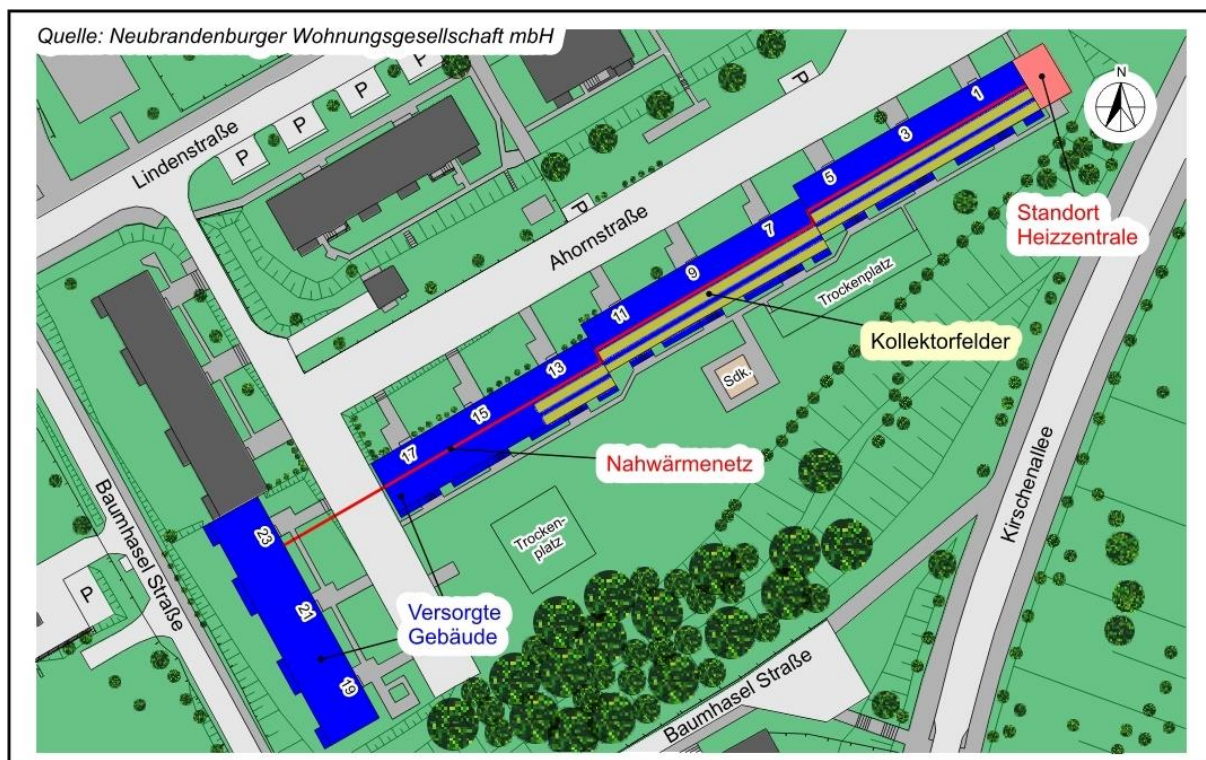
Lageplan Neubrandenburg, Ahornstraße 1 bis 23
